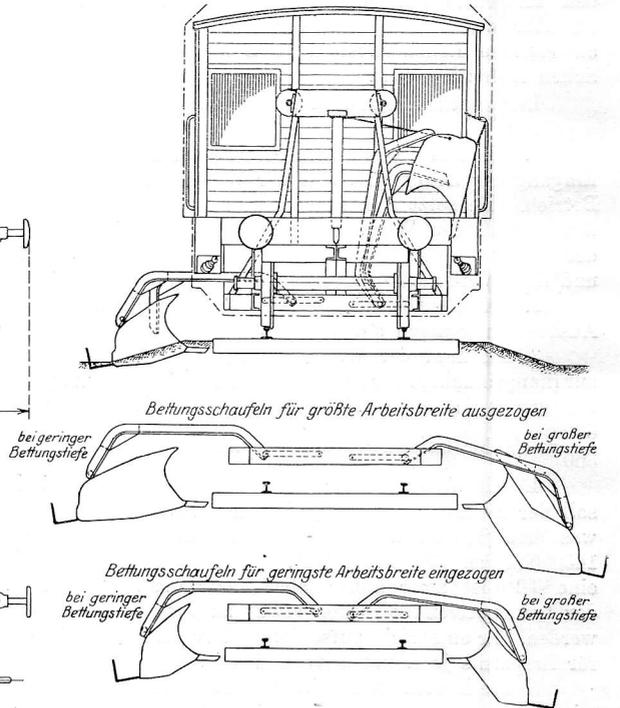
Endansicht und Einstellung der Bettungsschaufeln in verschiedenen Arbeitslagen
